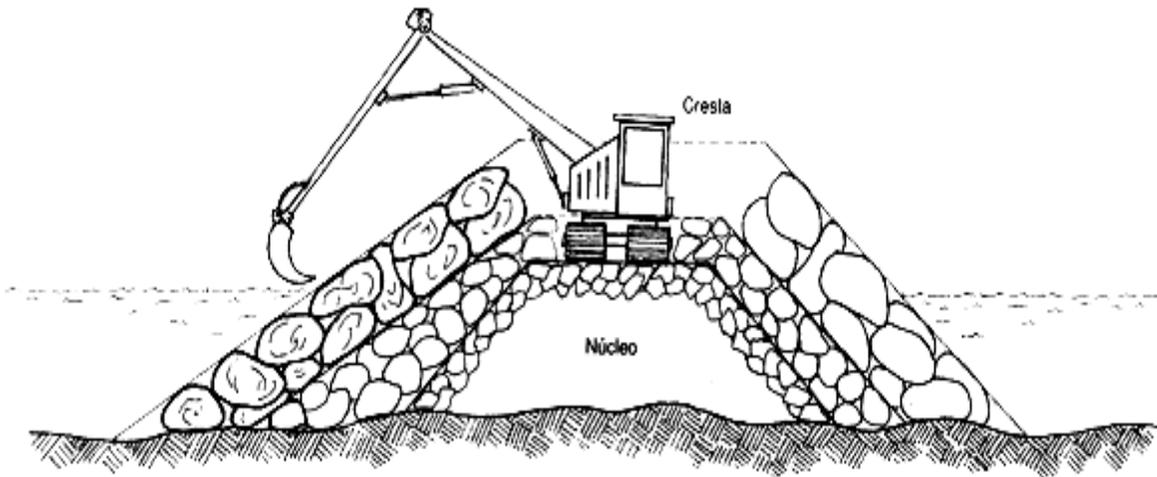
Excavadora hidráulica colocando la escollera sobre la cresta
